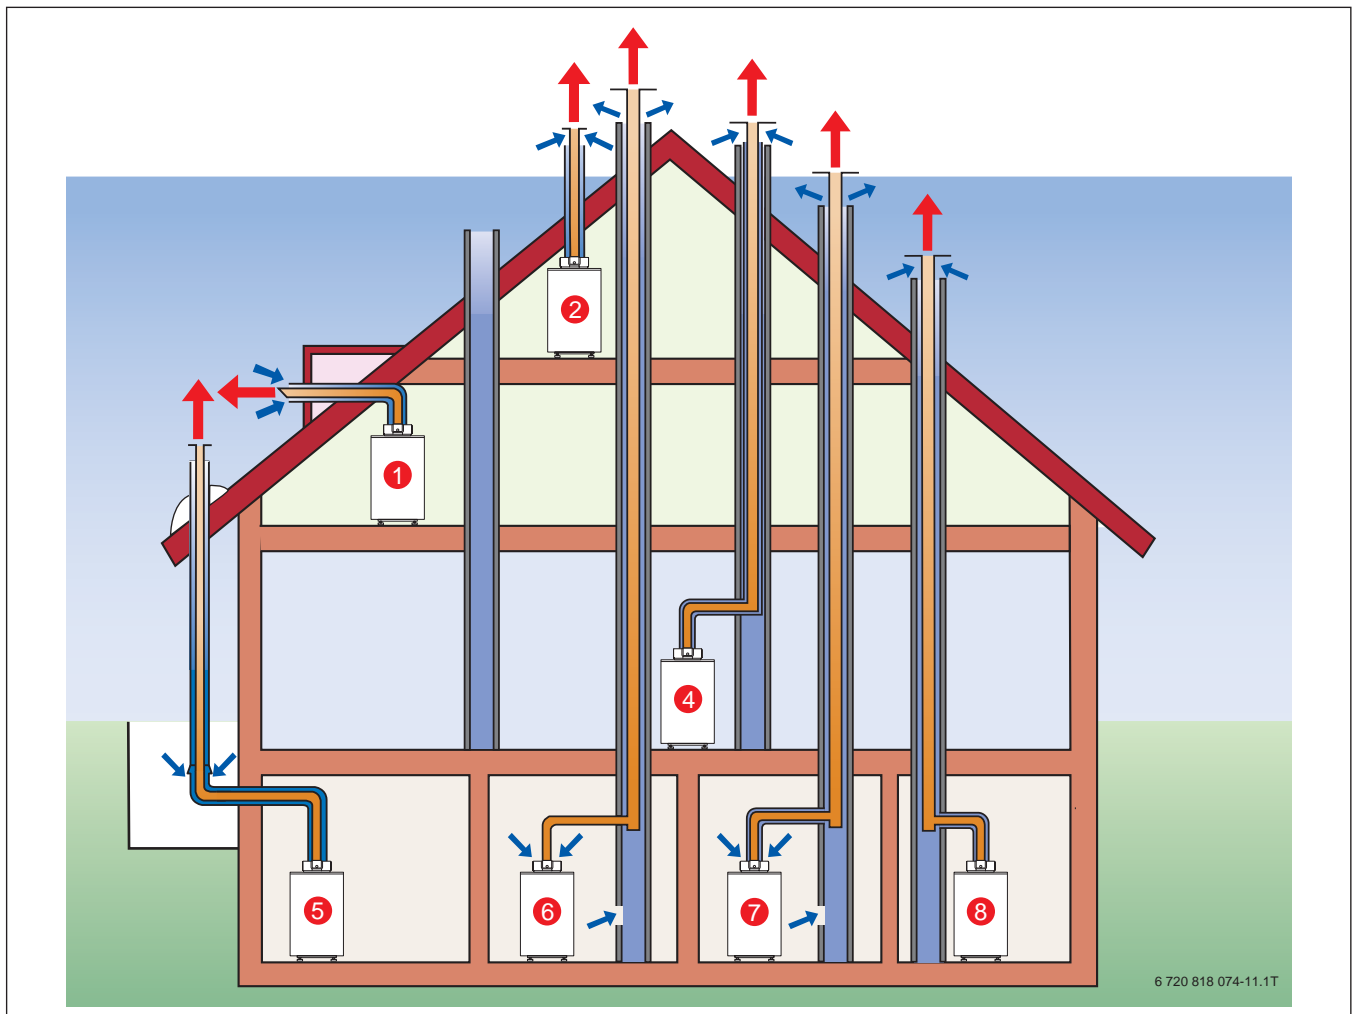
Übersicht Abgasführung für OC7000F 18 ... 49
